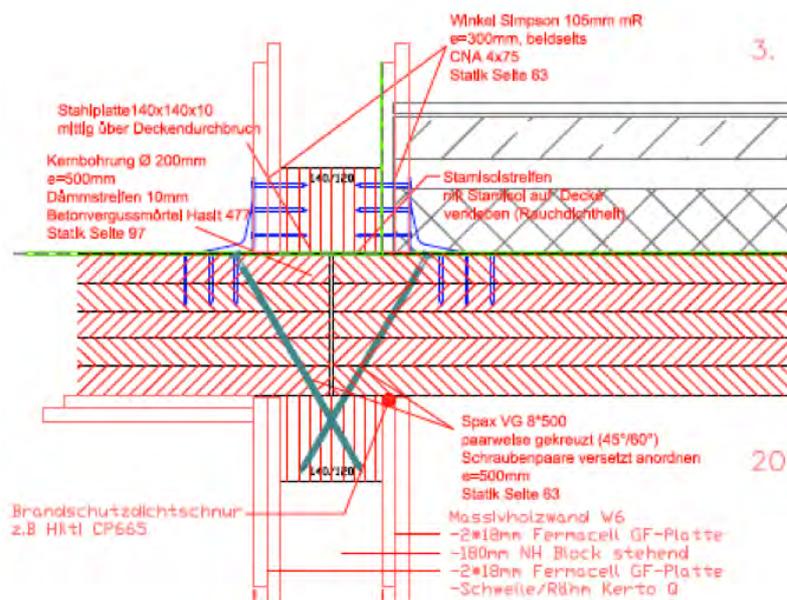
Anschluss raumabschließende Wand / Decke mit Brandschutzdichtschnur
